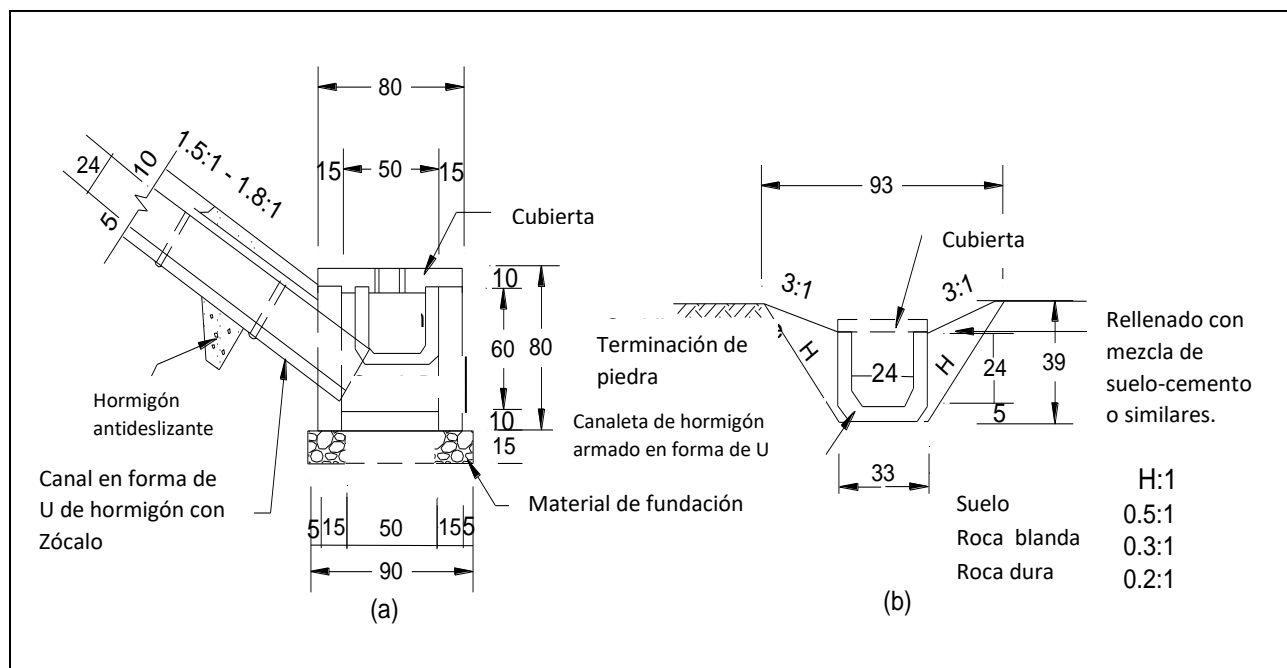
16 Imagen estructural del canal de drenaje, JICA, 2018
